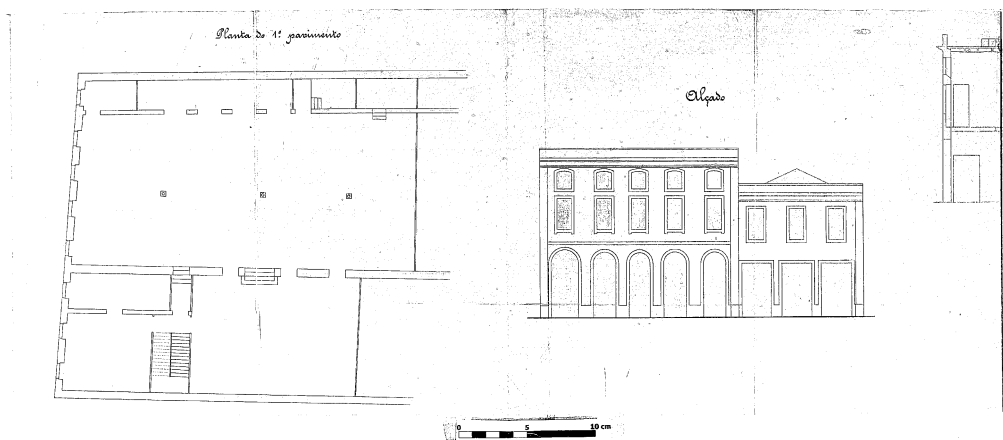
Planta do 1º pavimento da Fábrica Confiança, e alçados da Travessa Paços Manuel 1902.⁵¹
